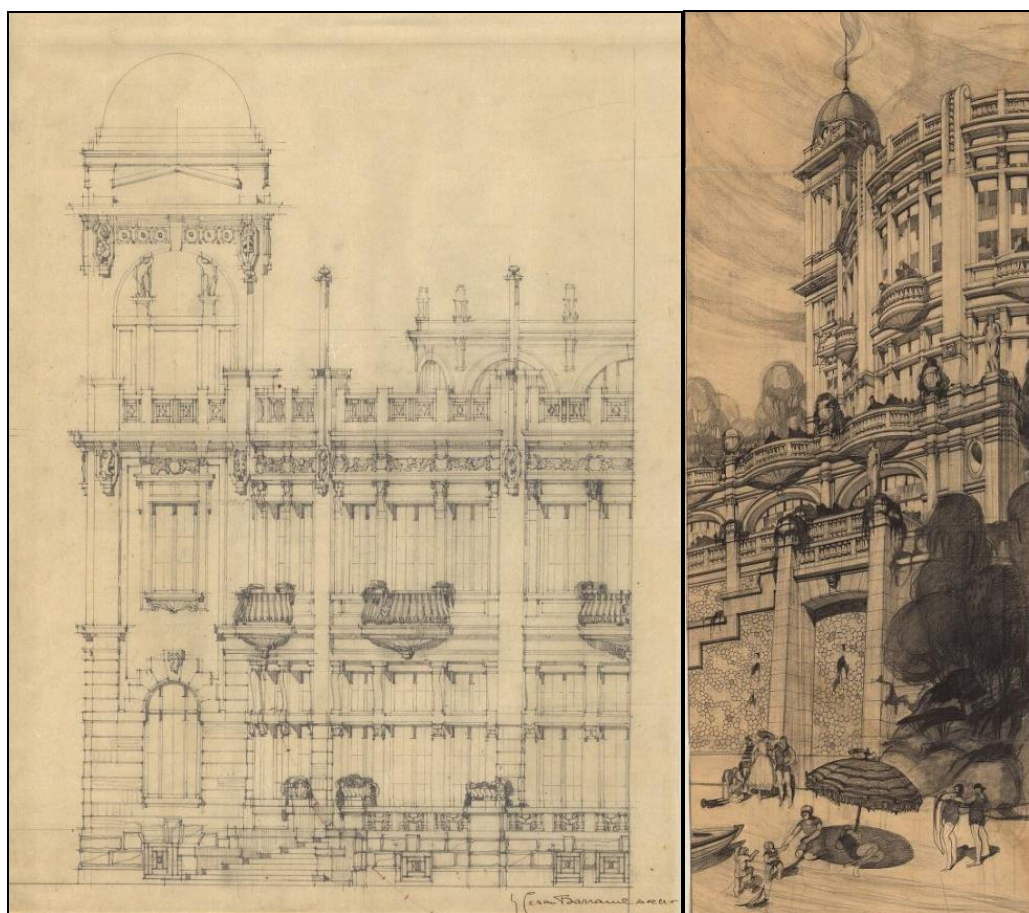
Studi del complesso – Archivio di Stato di Terni (Fondo Bazzani)
